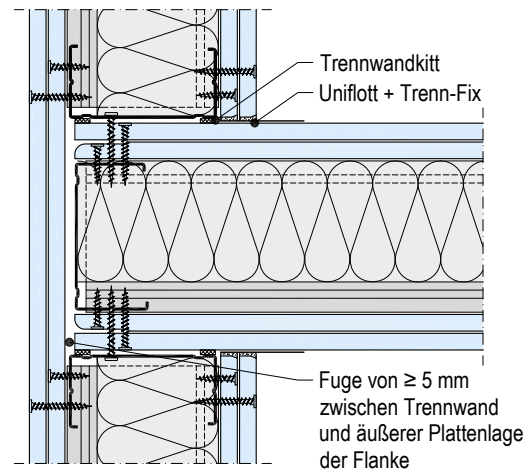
Darstellung Knauf Prüfaufbau Geschlitzte Flanke
